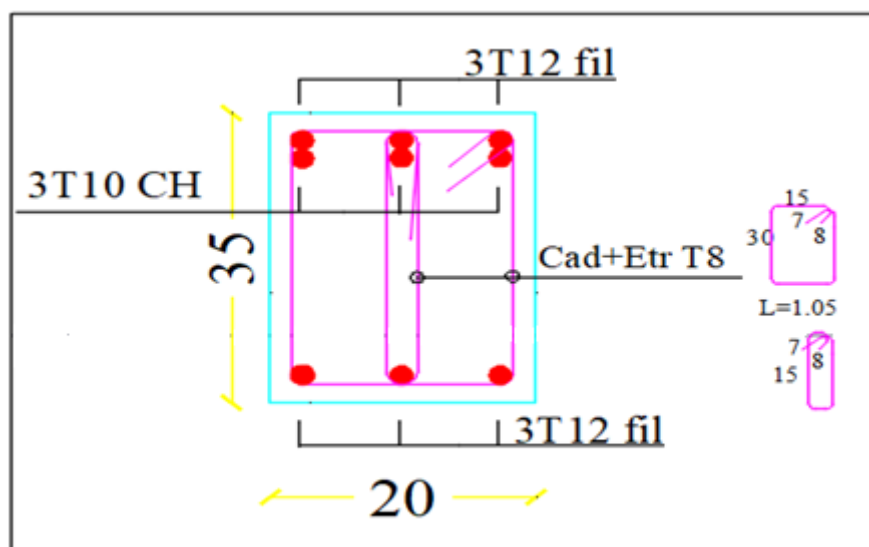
Ferrailage sur appuis d'une poutre principale.
